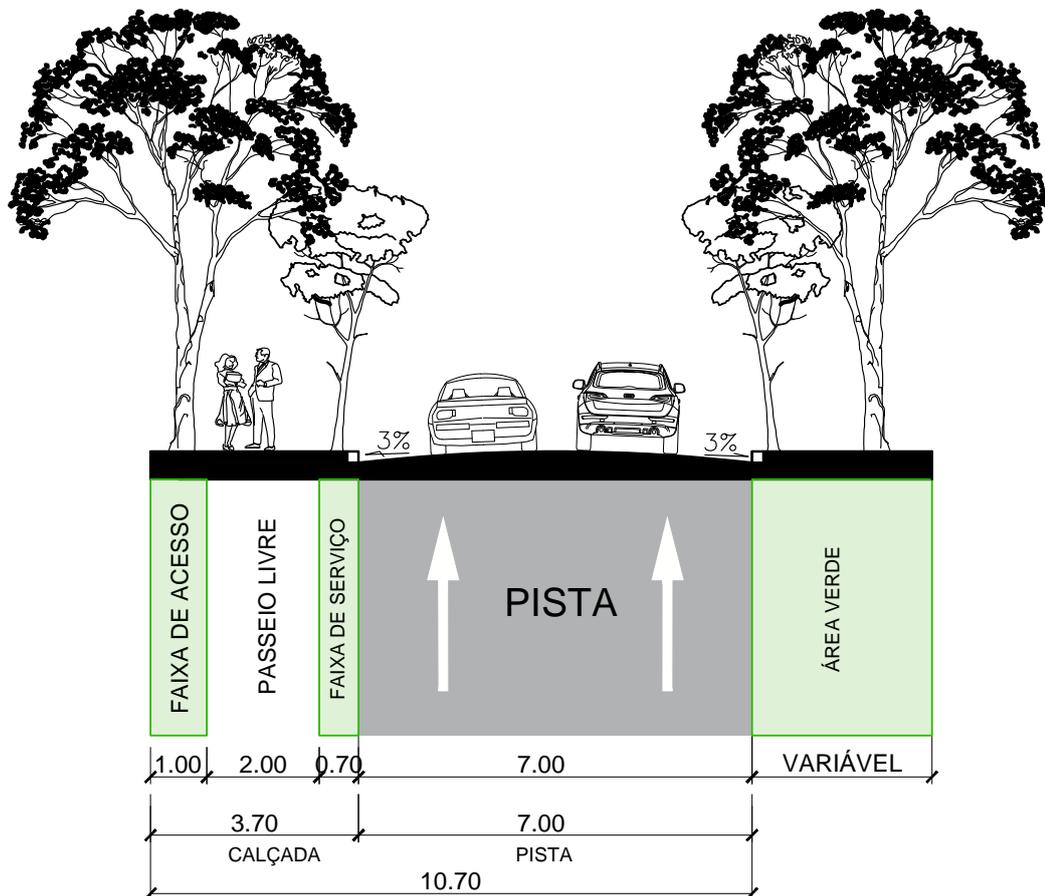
Perfil 05 – Rua Campo Limpo (Trecho da Bifurcação)
